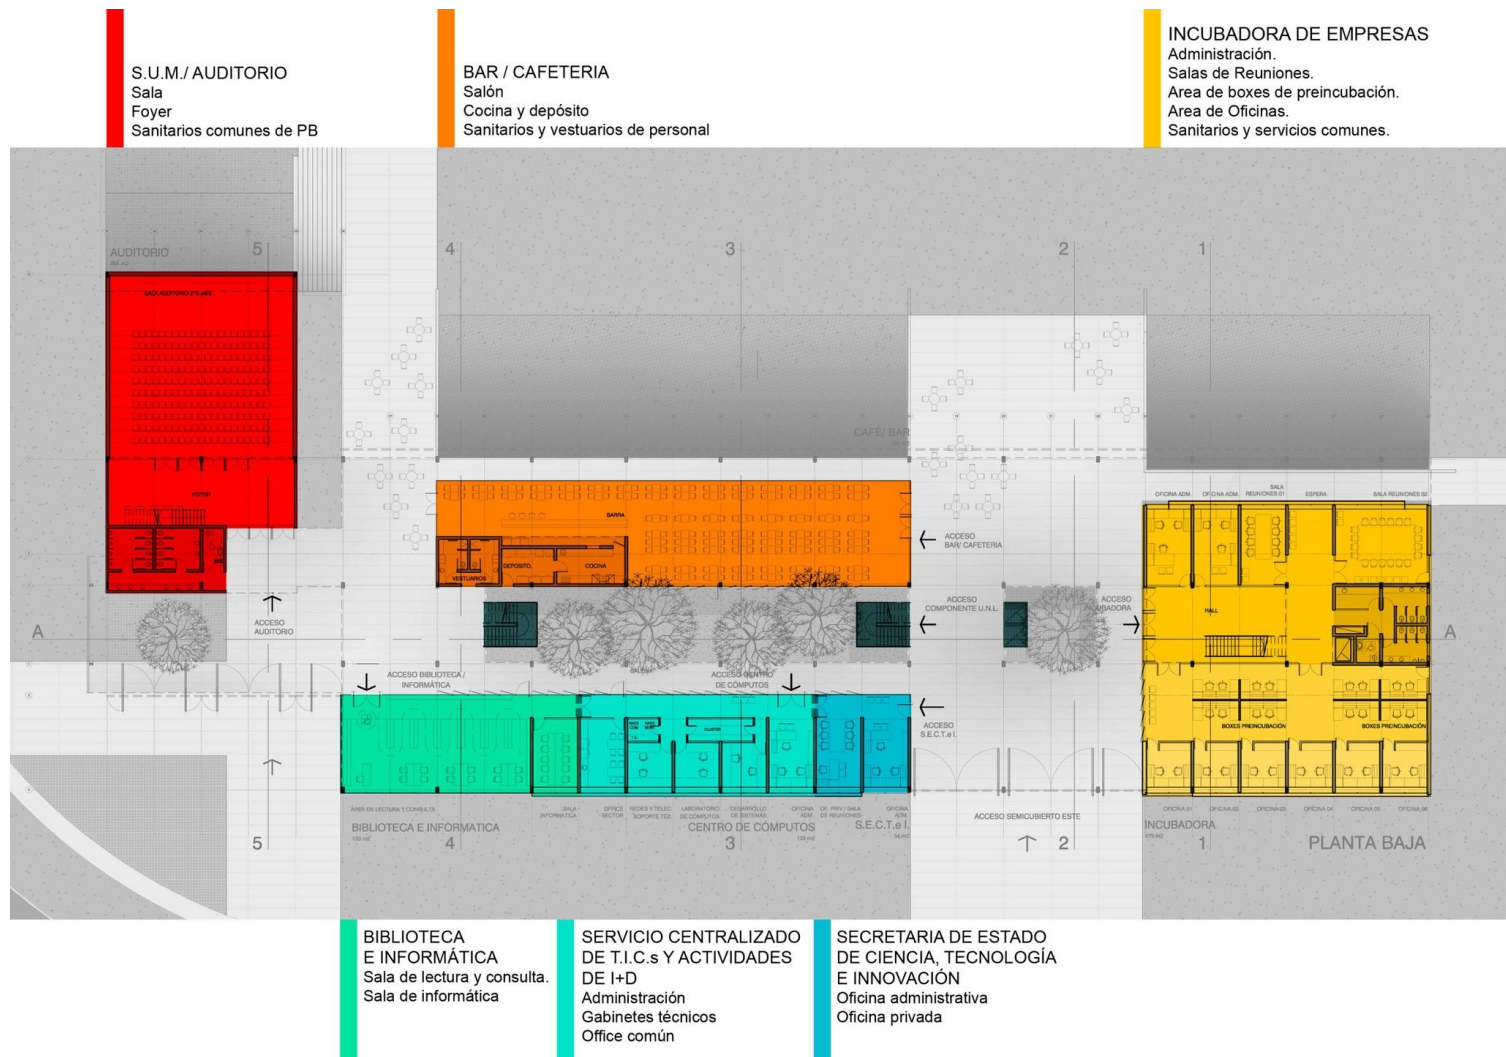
Proyecto arquitectónico – Plano de planta baja
